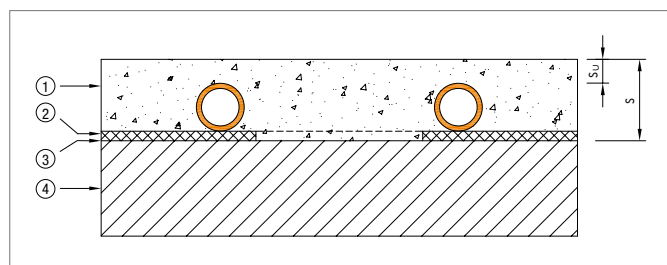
Prinzipaufbau Klettsystem RAUTHERM SPEED plus renova
